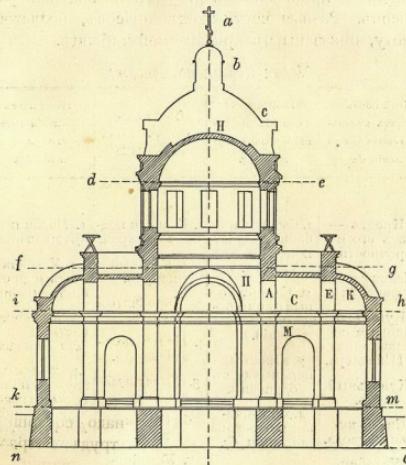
Разрѣз перекрытий въ масштабѣ 1/4 дюйма на сажень.
